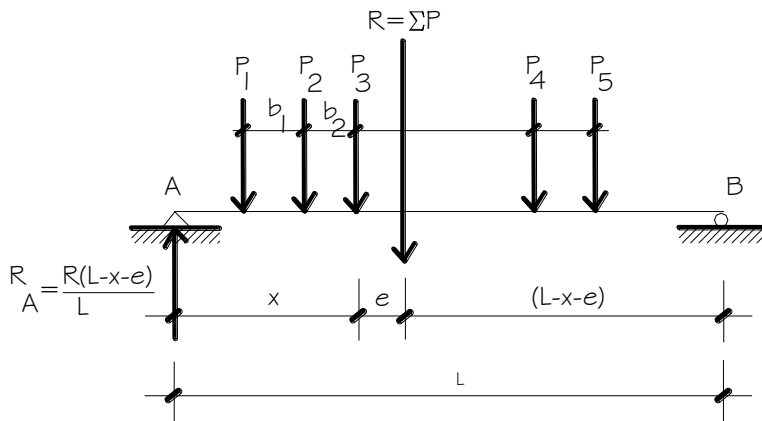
Tren de cargas sobre una viga simplemente apoyada
